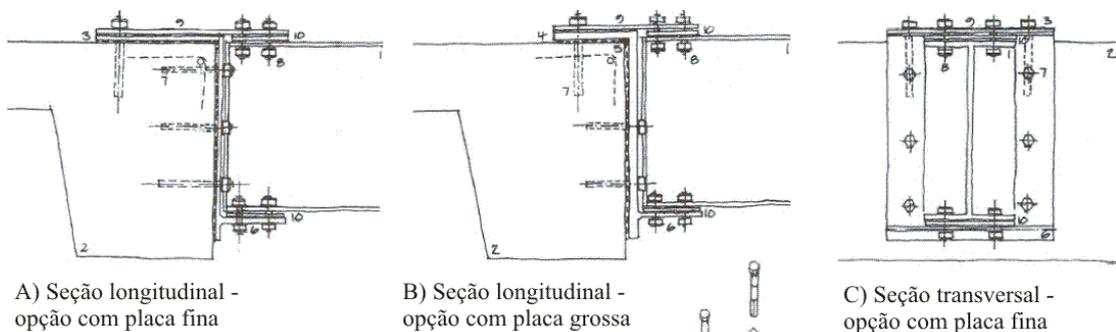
Carregamento em viga de aço simplesmente apoiada em viga de concreto.
